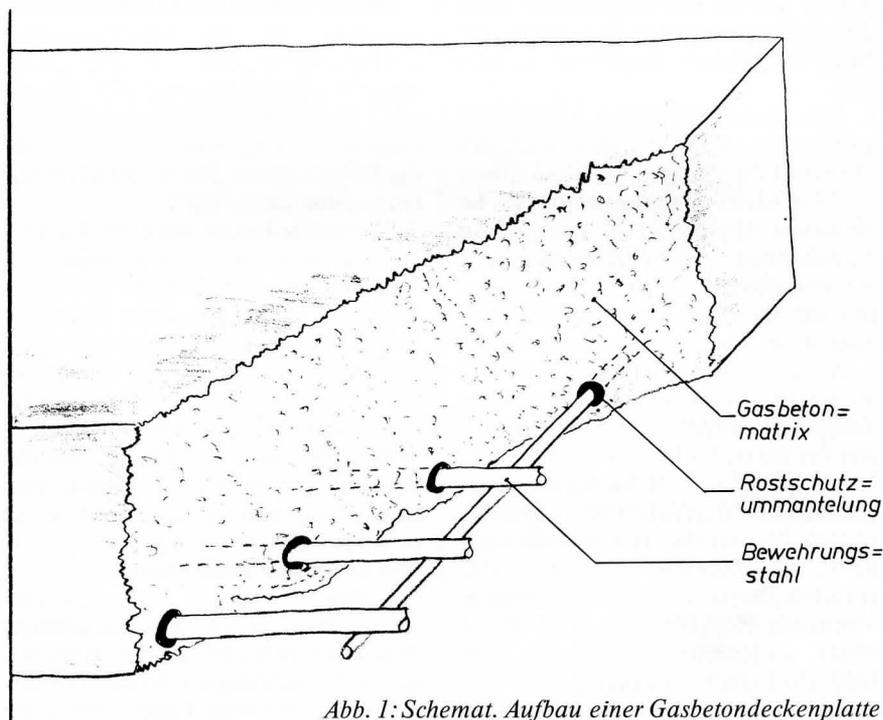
Schemat. Aufbau einer Gasbetondeckenplatte
